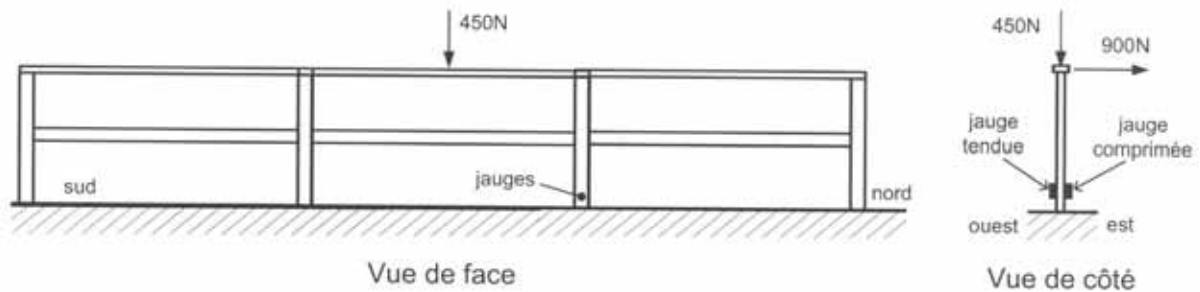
Essais statiques avec trois travées ancrées au parapet et charges sur la travée centrale.
